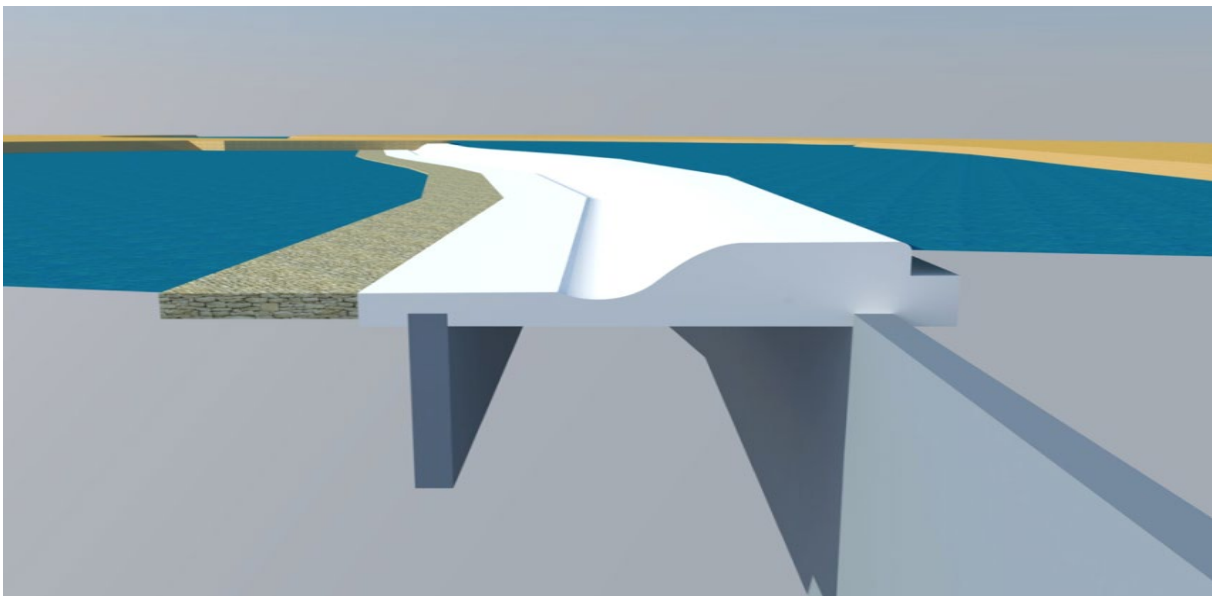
Vista definitiva reconstrucción azud de la Marquesa con pantallas bentonita cemento y escollera
